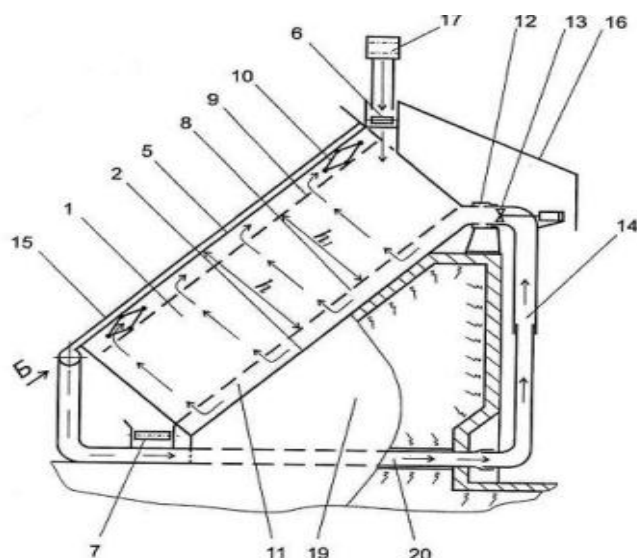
Загальний вигляд зерносховища-сушарки
